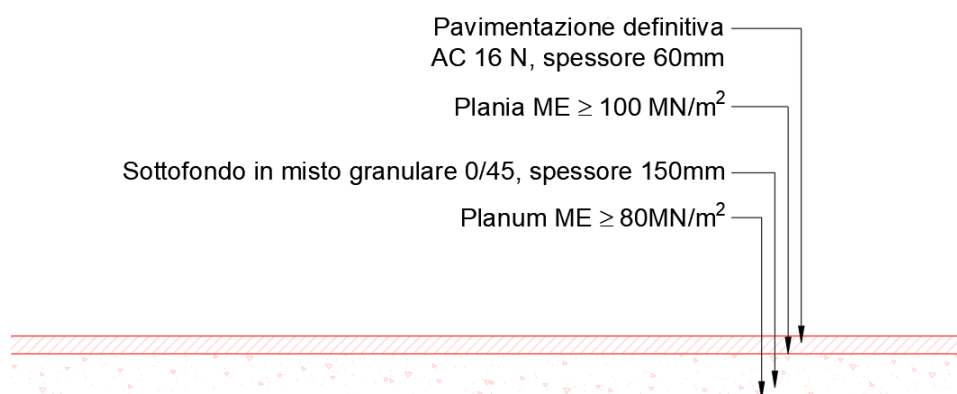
Stratigrafia pavimentazione definitiva di progetto della strada privata
